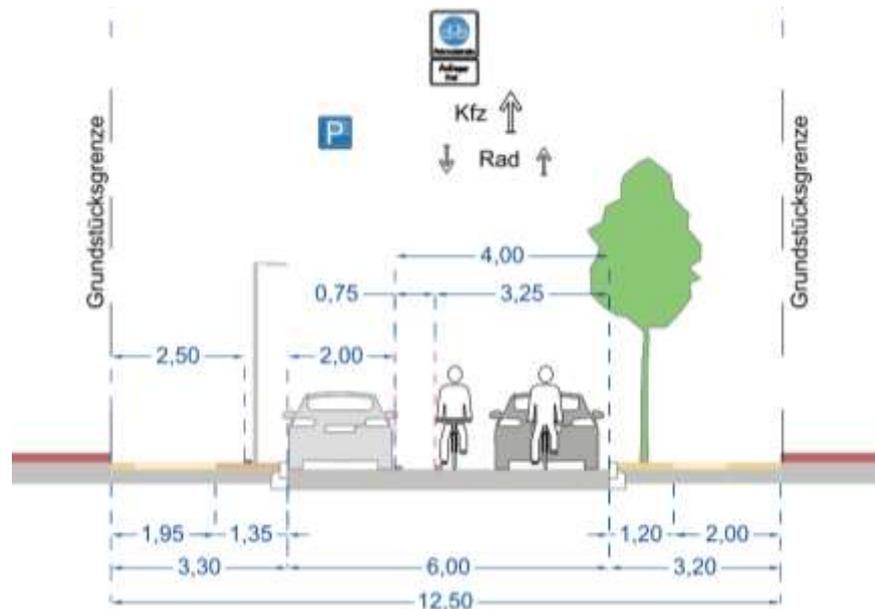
Straßenquerschnitt Cäsarstraße - Variante 3
